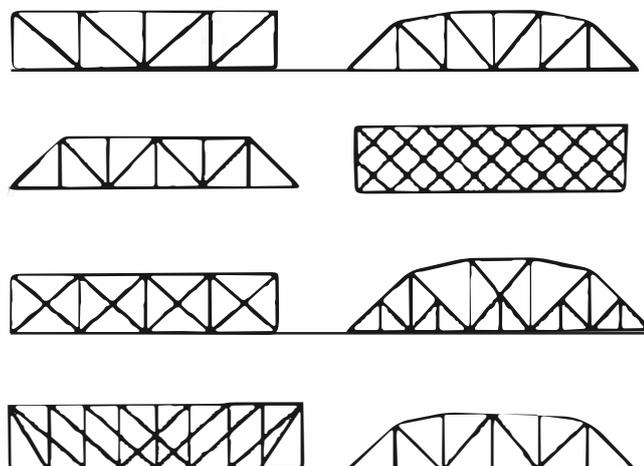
Celosías en pórticos con vigas laminadas o soldadas
